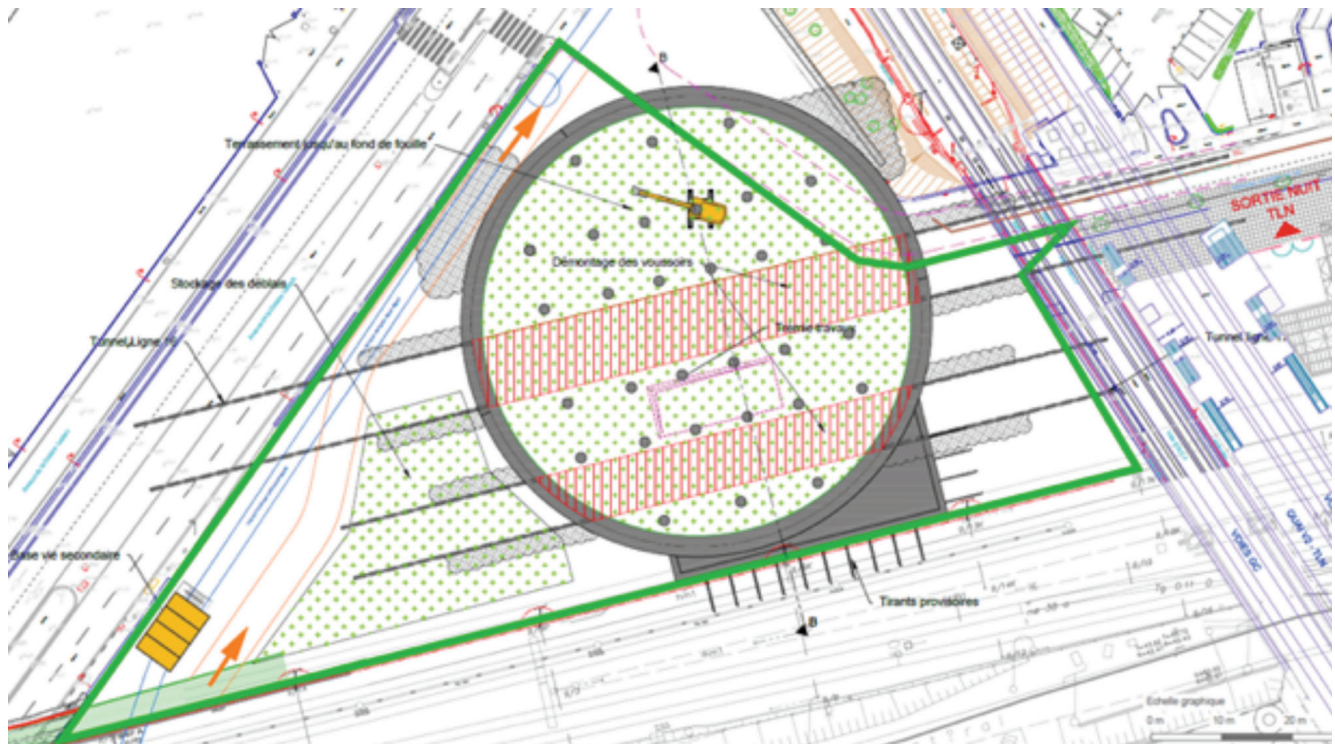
Terrassement jusqu'au niveau fond de fouille avec démontage des voussoirs - phases 9-11
